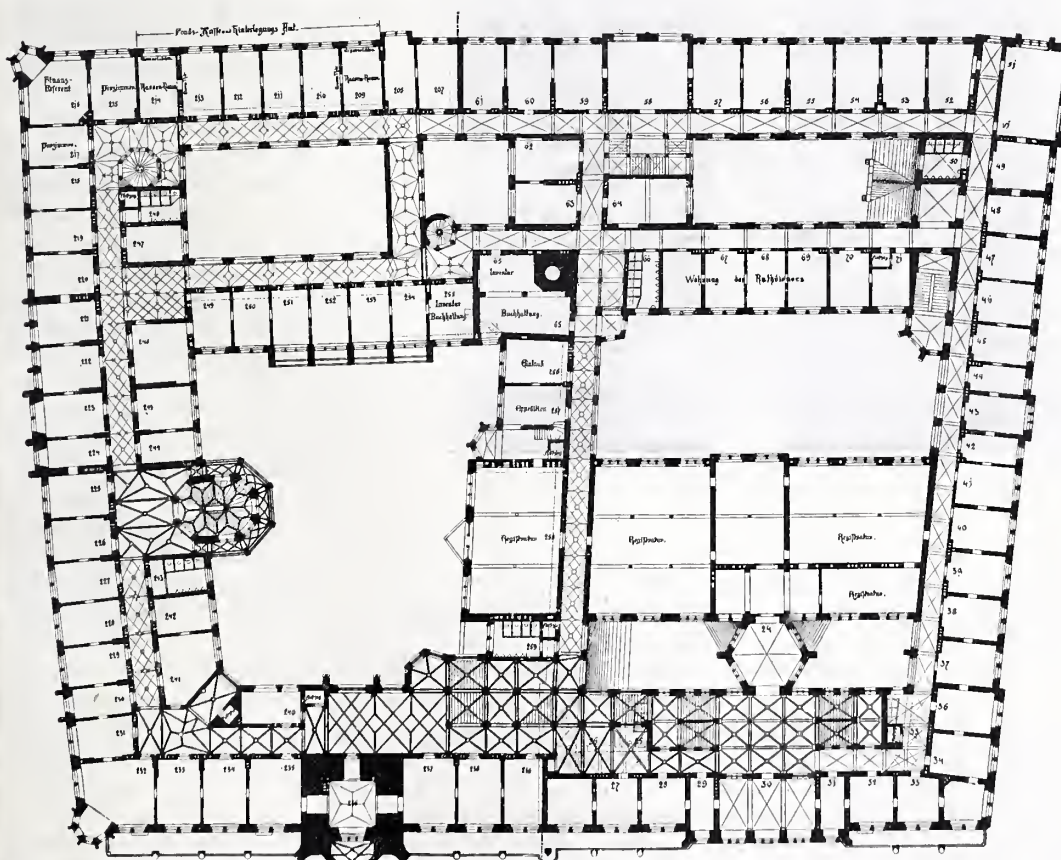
Grundriss vom I. Obergeschoss. — Masstab 1 : 800.
